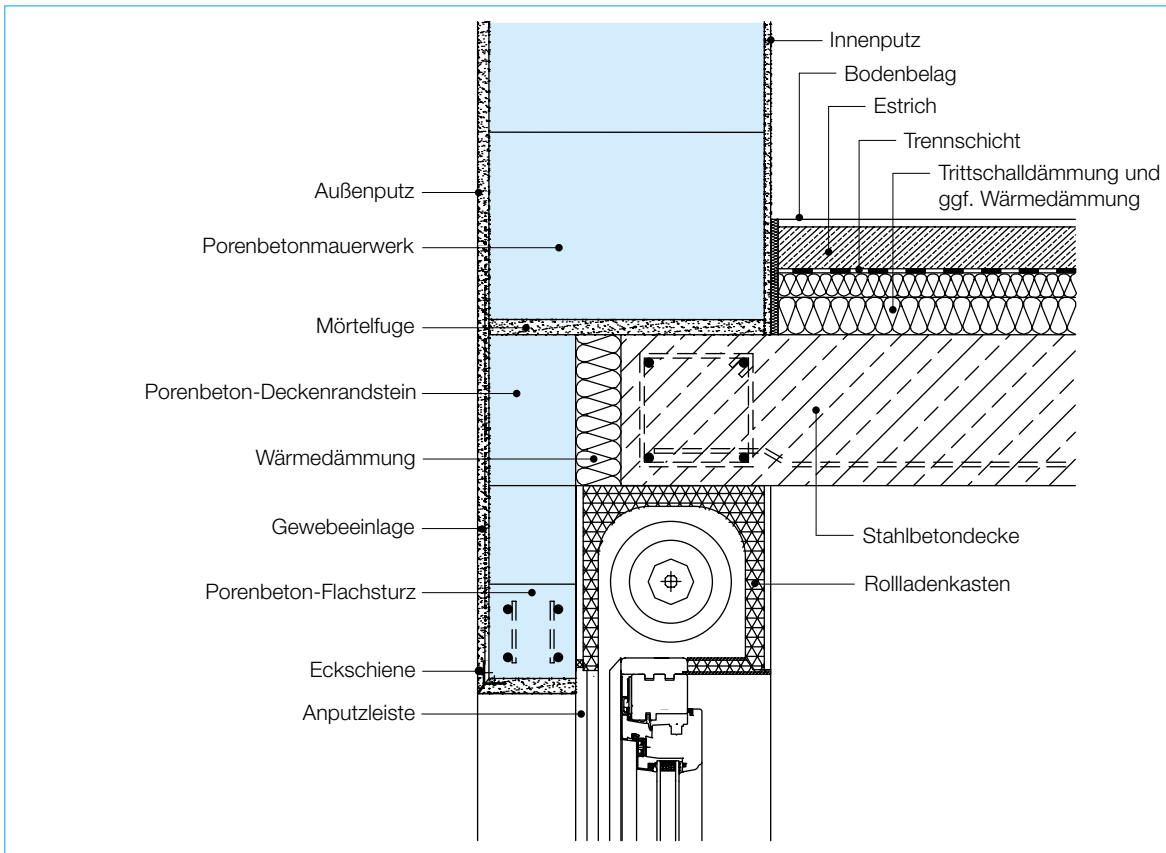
Einschalige Außenwand aus Porenbetonmauerwerk mit Anschluss an Stahlbetondecke und Rollladenkasten
